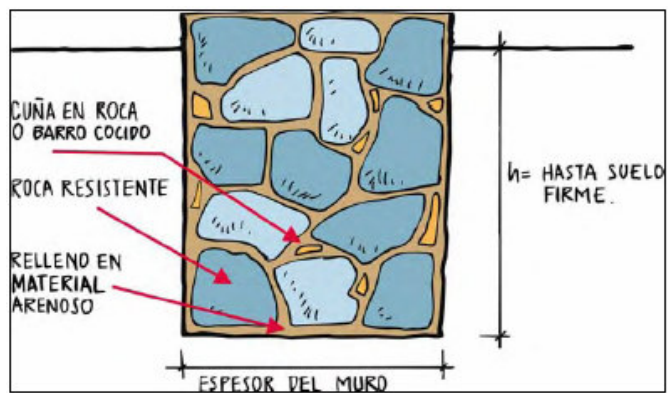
Cimentación mixta. Fuente: (Gómez, 2004).
